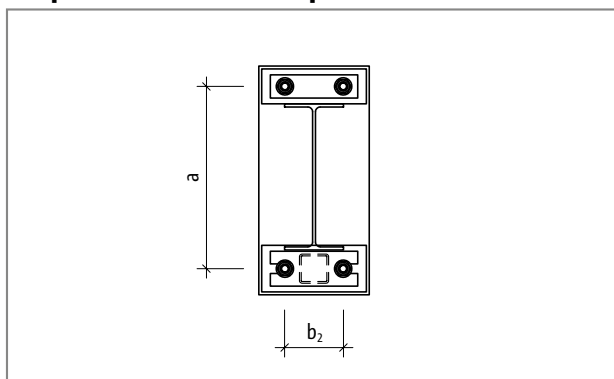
Plaque frontale saillante T type S : calcul des entrées géométriques ; vue globale
